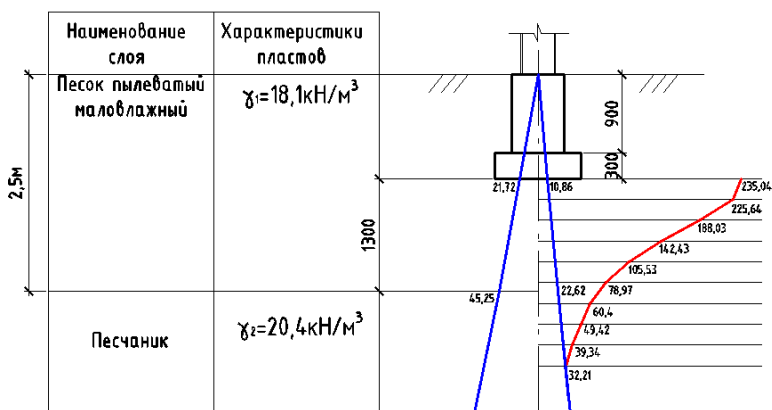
Определения осадки фундамента для средней колонны
